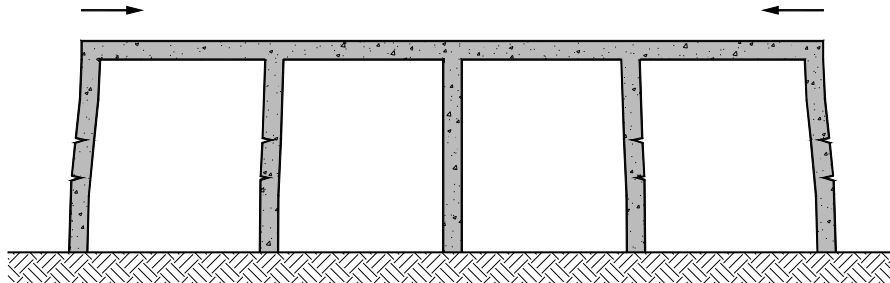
Fissuras horizontais nos pilares, devidas à retracção do betão das vigas superiores [30]
